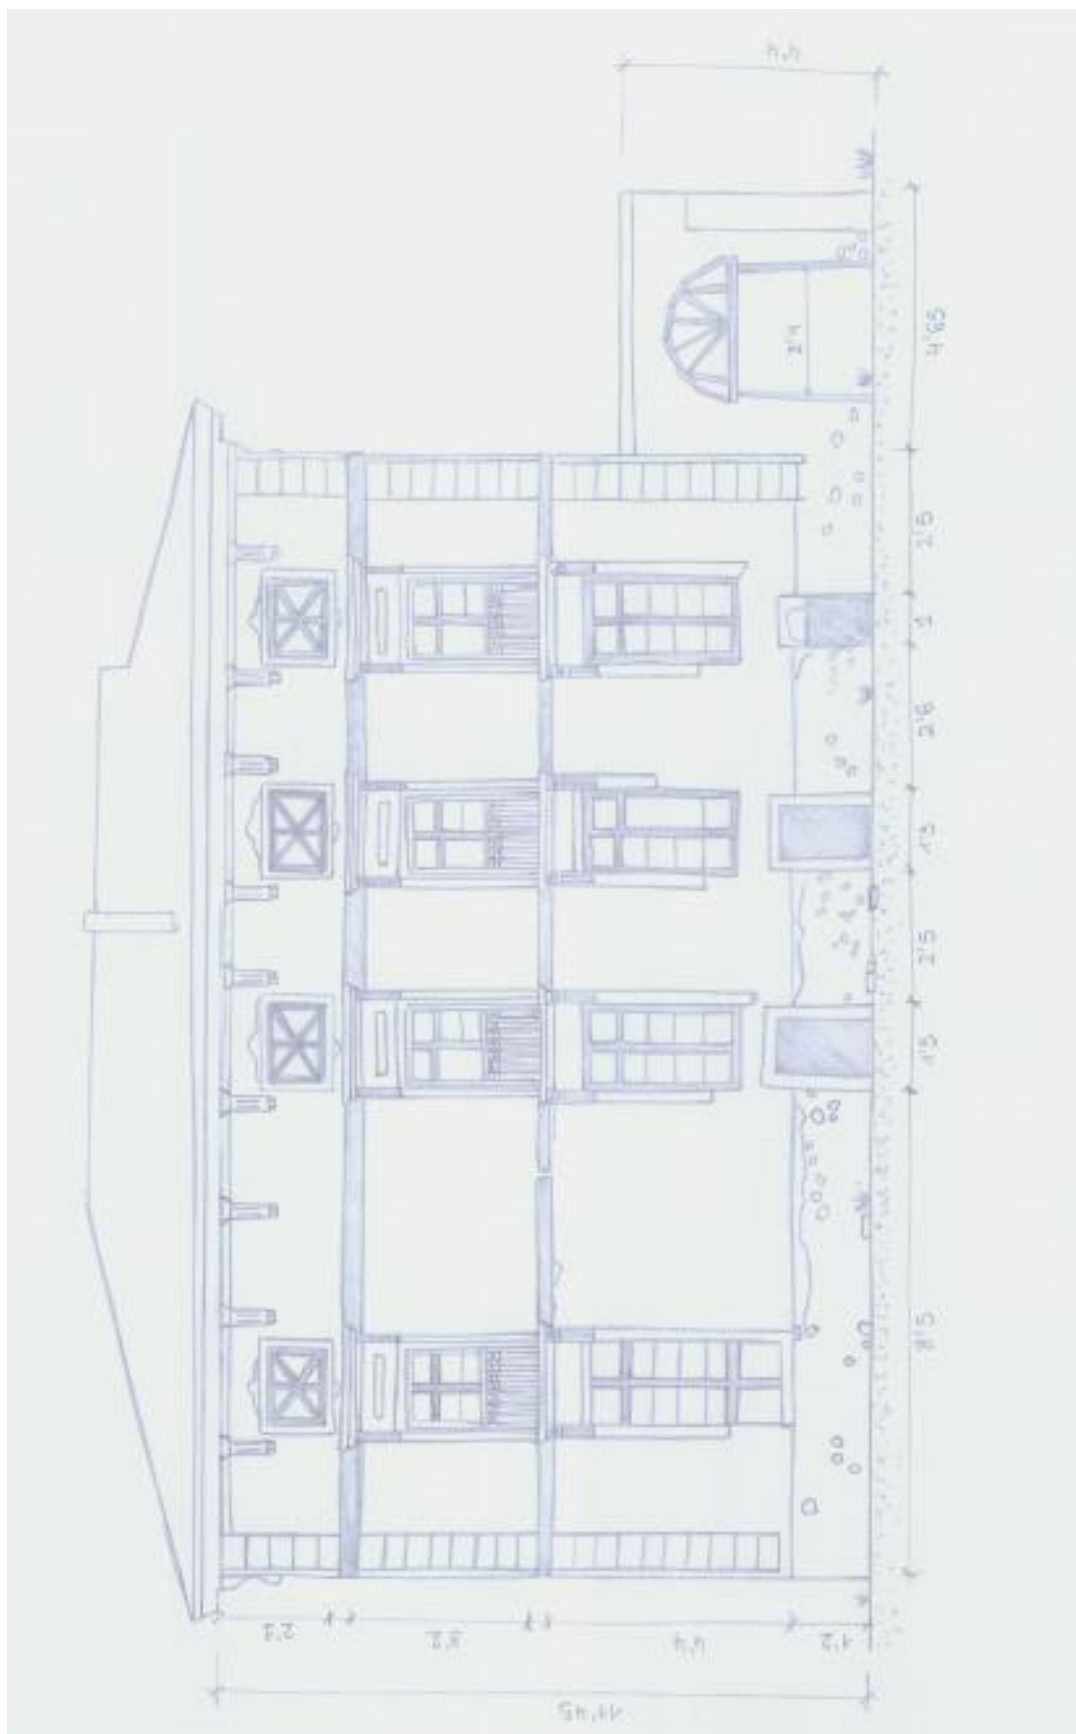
Croquis Alzado Jardín B. Fuente: Elaboración propia
